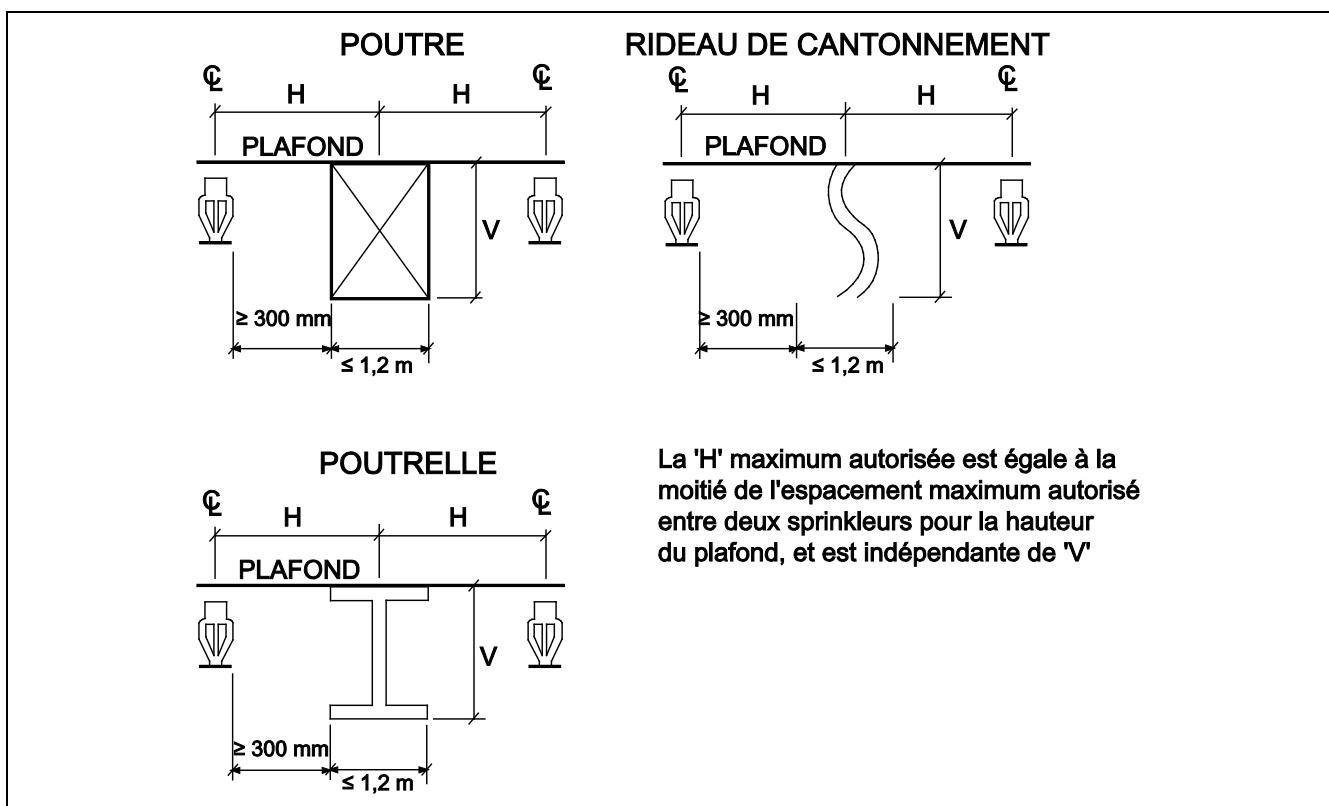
Sprinkleurs supplémentaires installés pour réduire l'obstruction au profil de distribution par des objets pleins en toiture.
